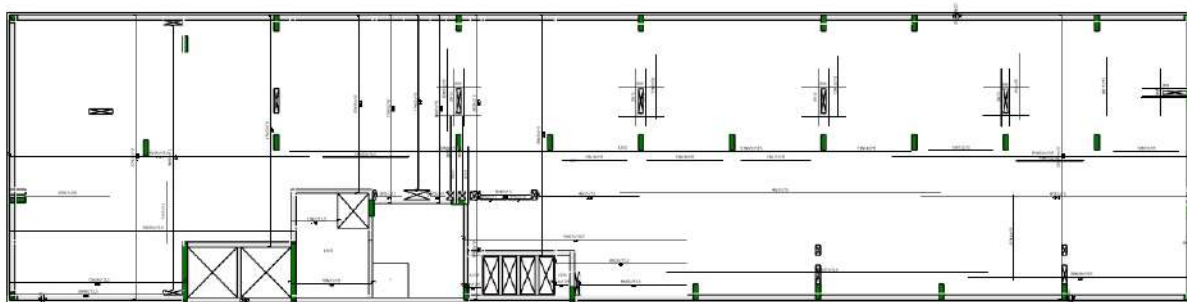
Localização das vistas de detalhamento das lajes do 3º pavimento.
